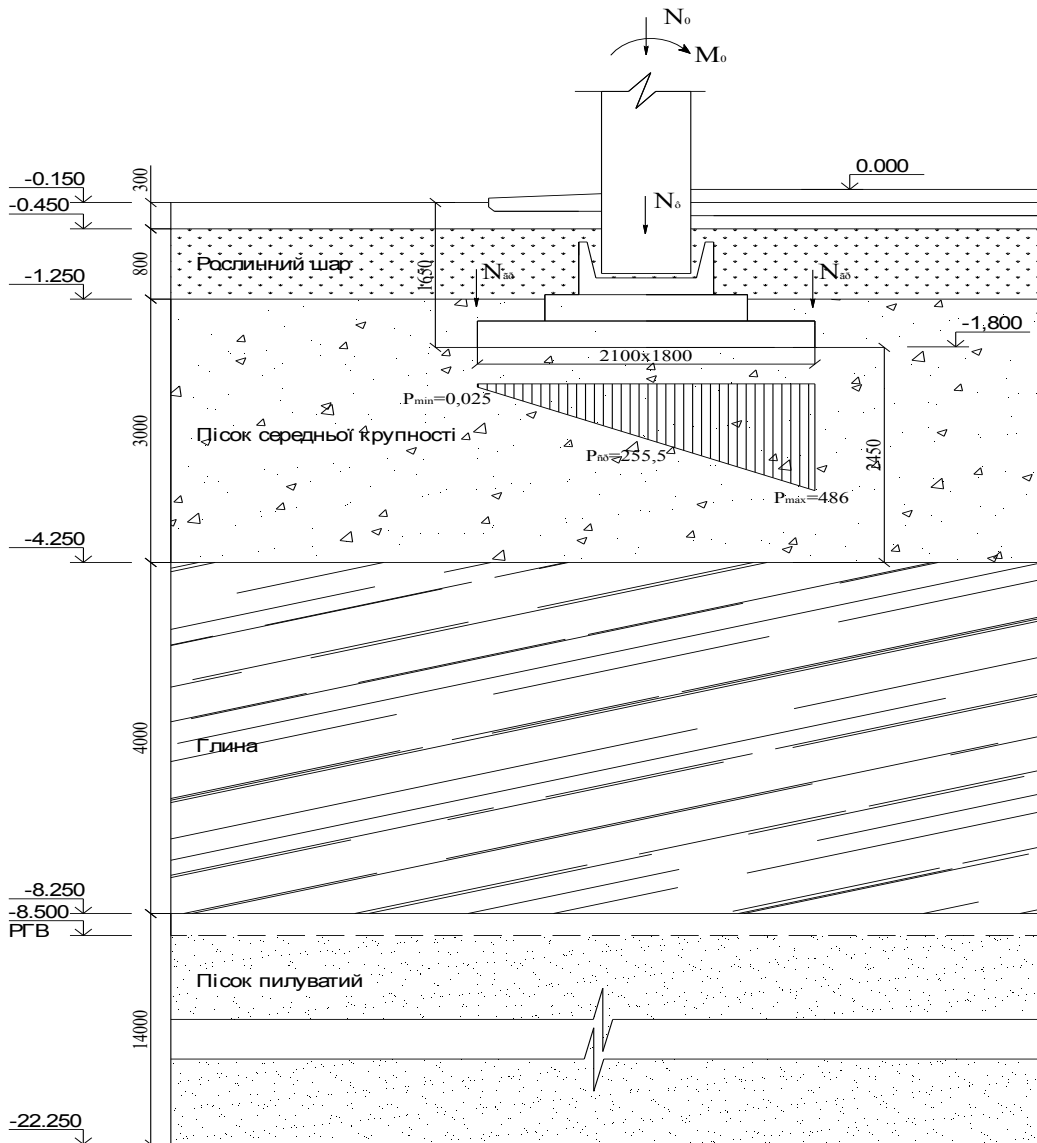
Навантаження від фундаменту мілкого залягання
